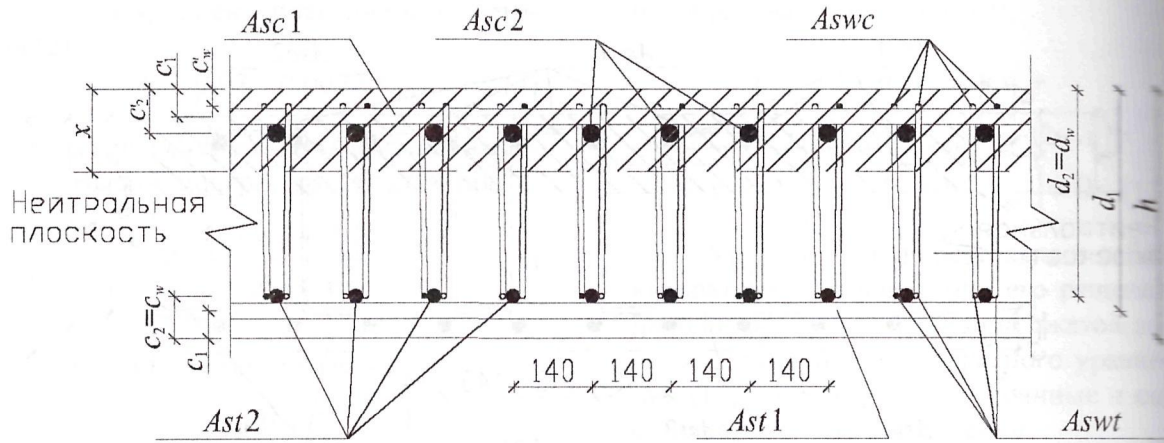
Фрагмент продольного армирования шестиугольной железобетонной плиты с расположением сжатой зоны в верхней части сечения (сечения 3-3 и 4-4)
